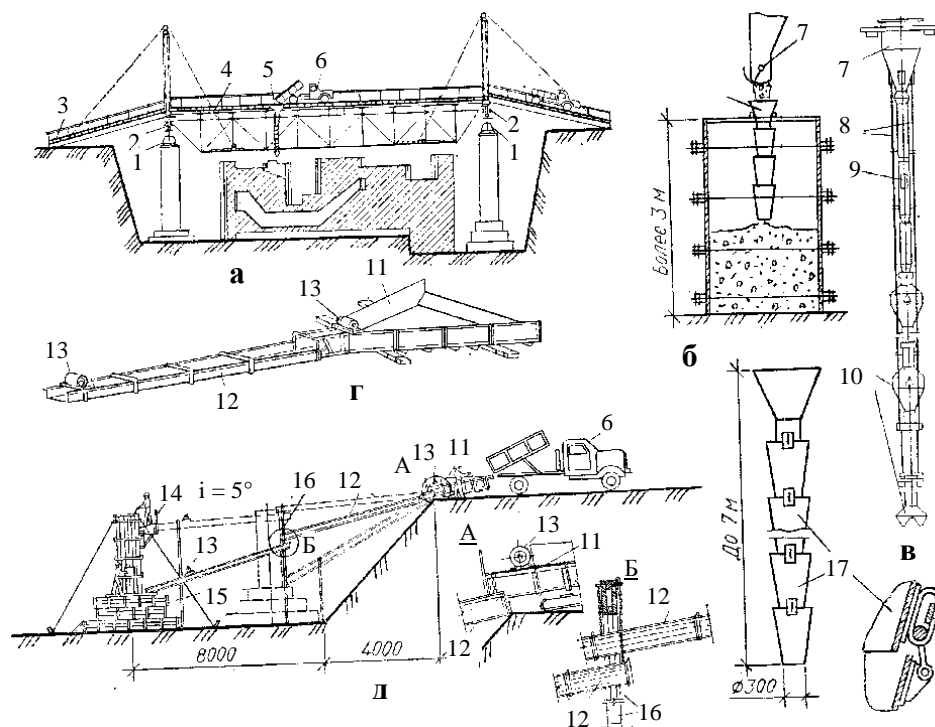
Схеми подавання бетонної суміші: а – бетонування фундаменту під технологічне обладнання з пересувного моста; б – ланковий хобот; в – вібраційний хобот; г – віброживильники та вібраційний жолоб; д – бетонування східчастого фундаменту за допомогою вібраційного конвеєра; 1 – рейки; 2 – котки пересувного моста; 3 – в'їзний пандус; 4 – міст; 5 – ланковий хобот; 6 – автобетоновоз; 7 – лійка; 8 – троси; 9 – вібратор; 10 – гасники; 11 – віброживильники; 12 – вібраційний жолоб; 13 – вібратори; 14 – підмостки; 15 – східчастий фундамент; 16 – стояки; 17 – кріплення елементів хобота
